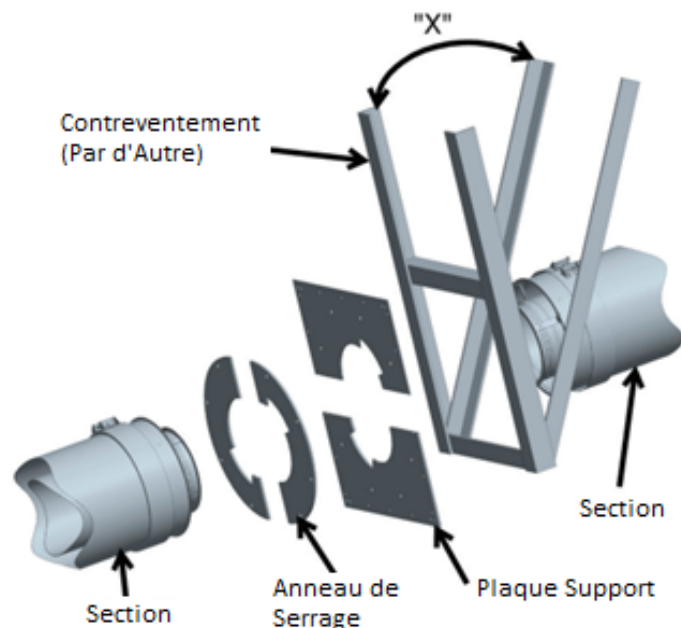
Contreventement horizontal de la plaque d'ancrage
